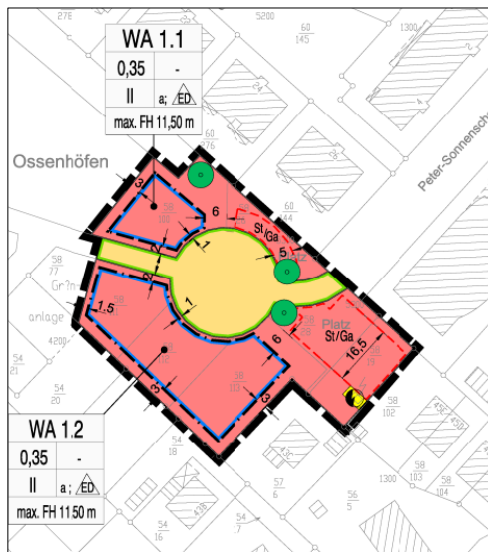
Bebauungsplan Nr. 76 „Ossenhöfe I“ – 5. Änderung (links)
